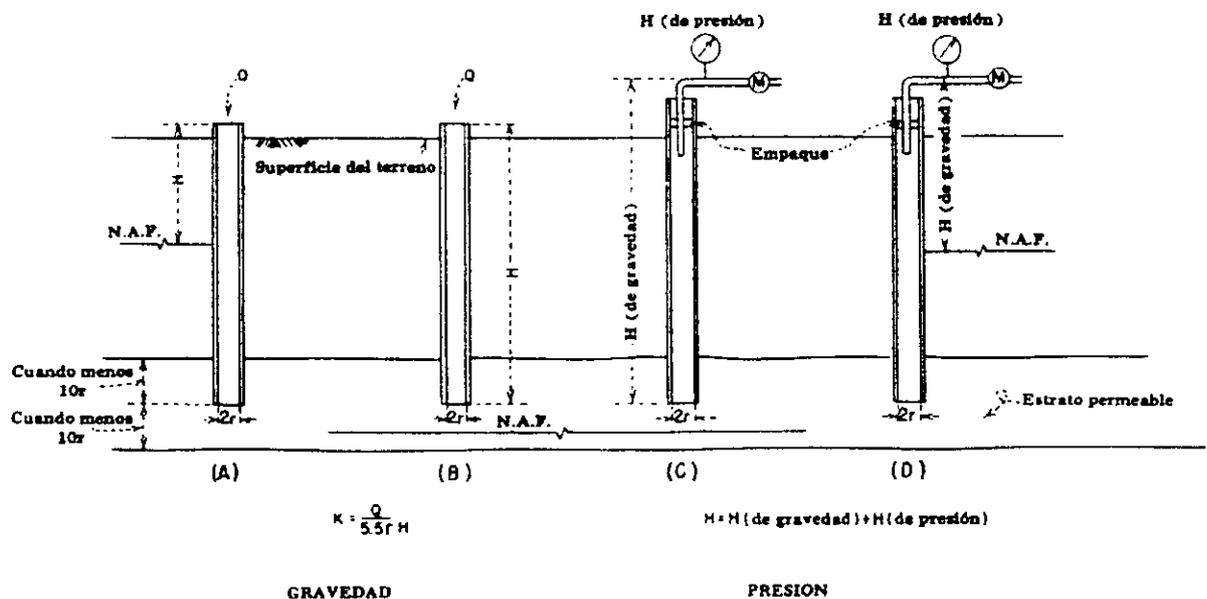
Prueba con tubo abierto para determinar la permeabilidad de los suelos, que se puede hacer en el campo.
